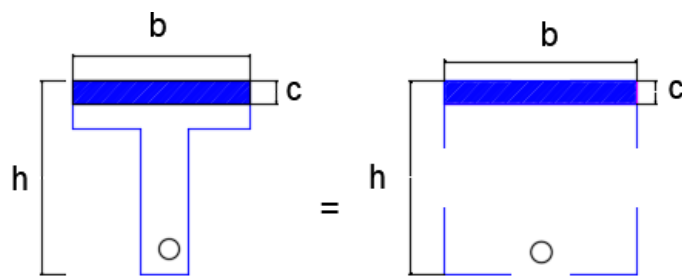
Viga “T”, con un eje neutro dentro del espesor de la losa.
